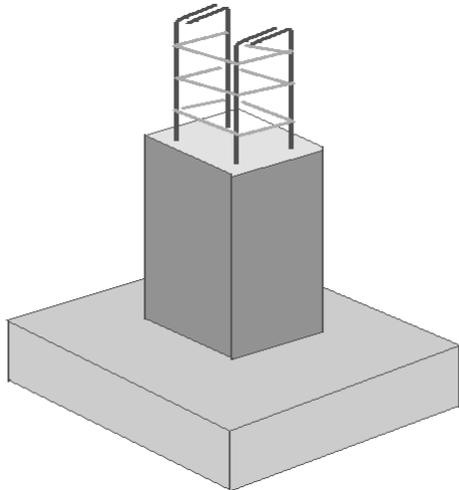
Forma que debería tener una zapata prefabricada para enlazarse con una estructura construida en acero.
